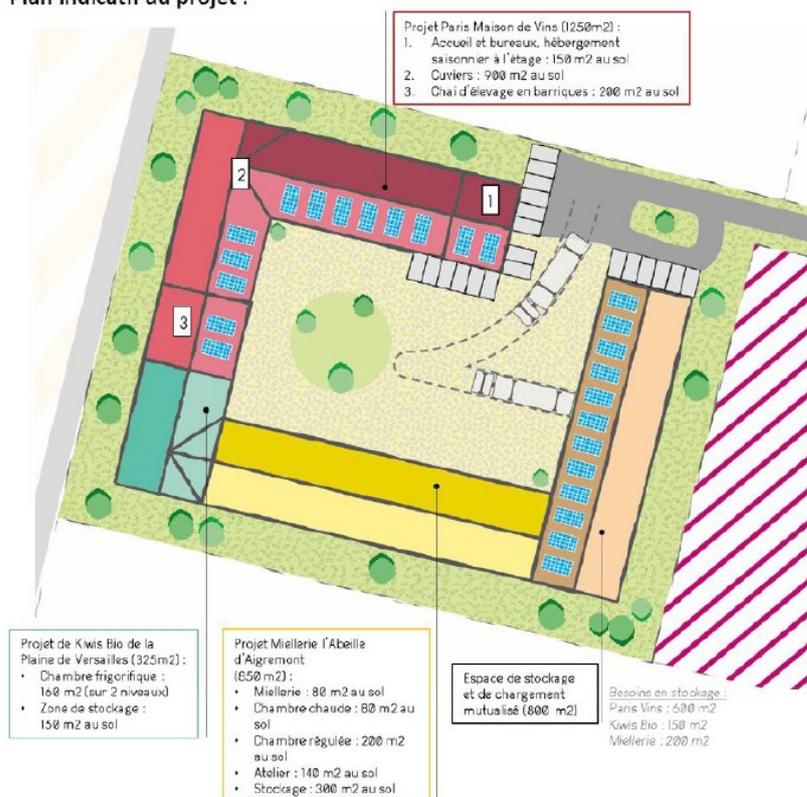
Plan indicatif du projet de « hameau agricole » (source : note de présentation, p. 29)
